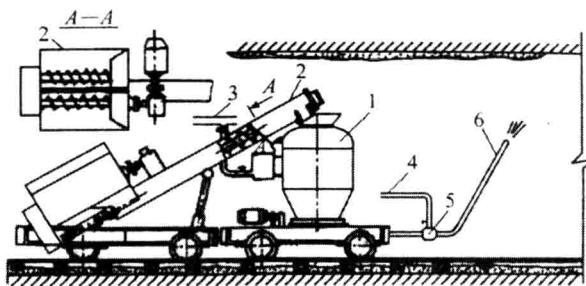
喷射机与搅拌机配套喷射混凝土施工
